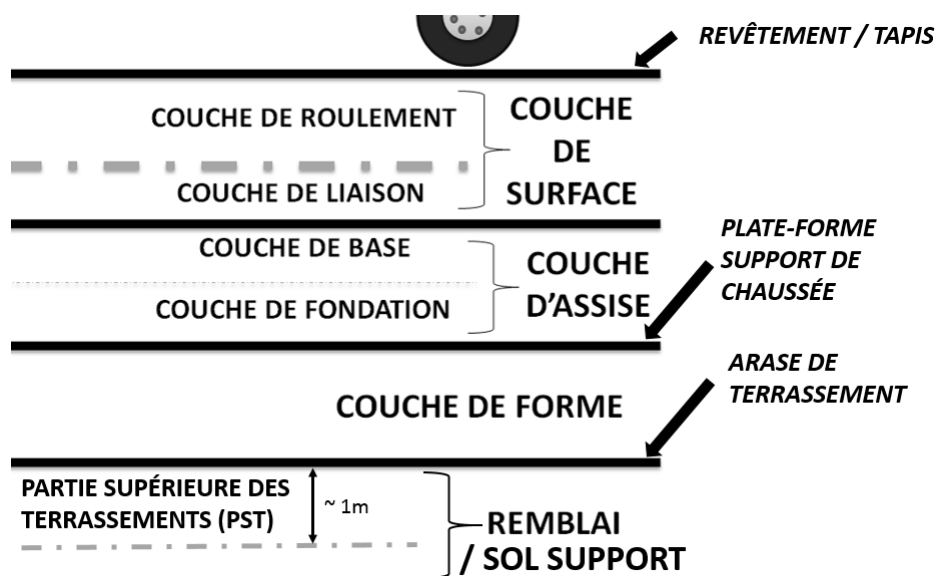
Coupe d'une route : couches de chaussée et des terrassements
